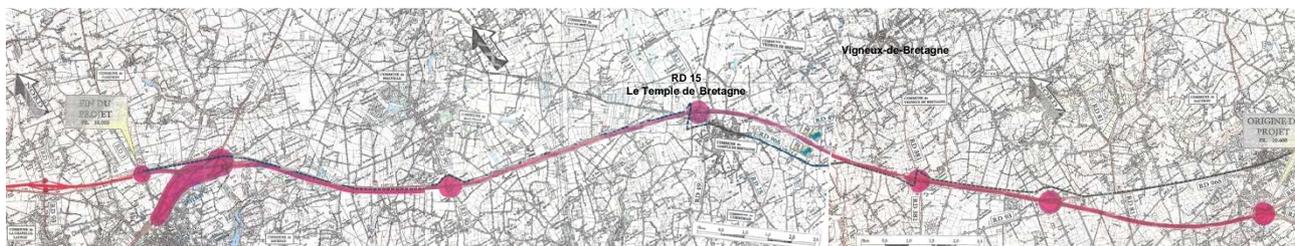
Plan général des travaux de mise aux normes autoroutières de la RN165
